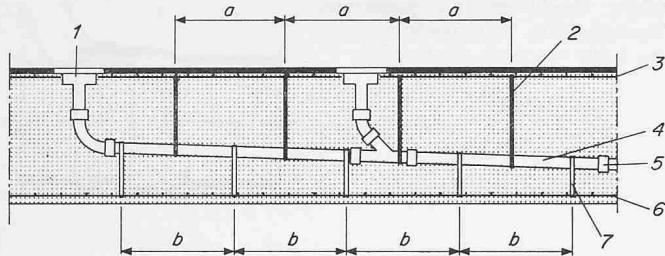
Schnitt durch ein Tragwerk mit einbetonierten PVC-Rohren.
